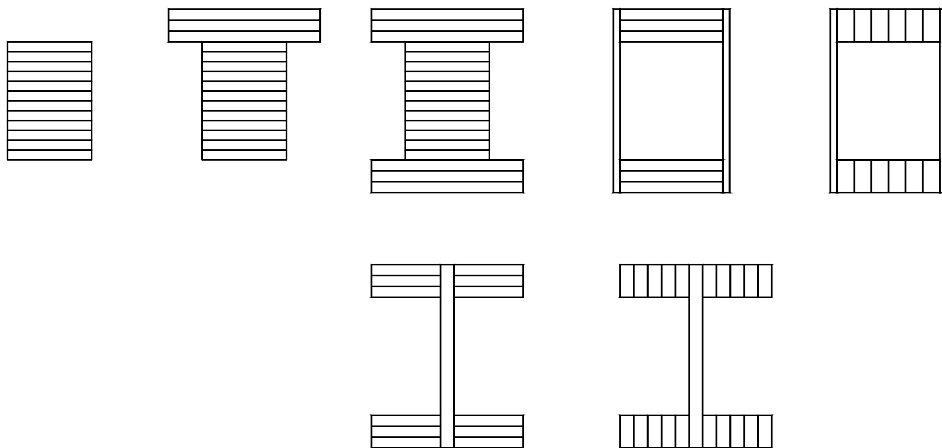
Secciones transversales de vigas rectas de madera laminada.
